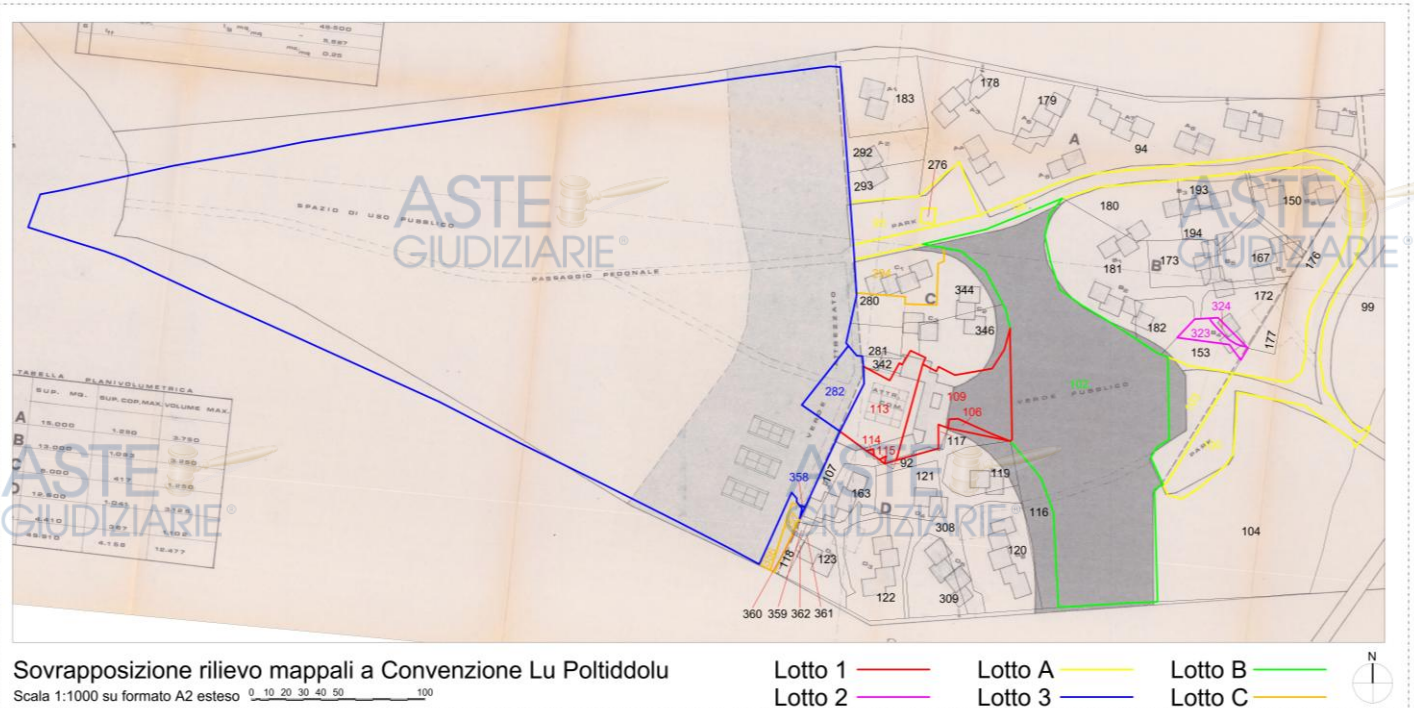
Tavola 2 allegata alla Convenzione – Sistemazione planivolumetrica
